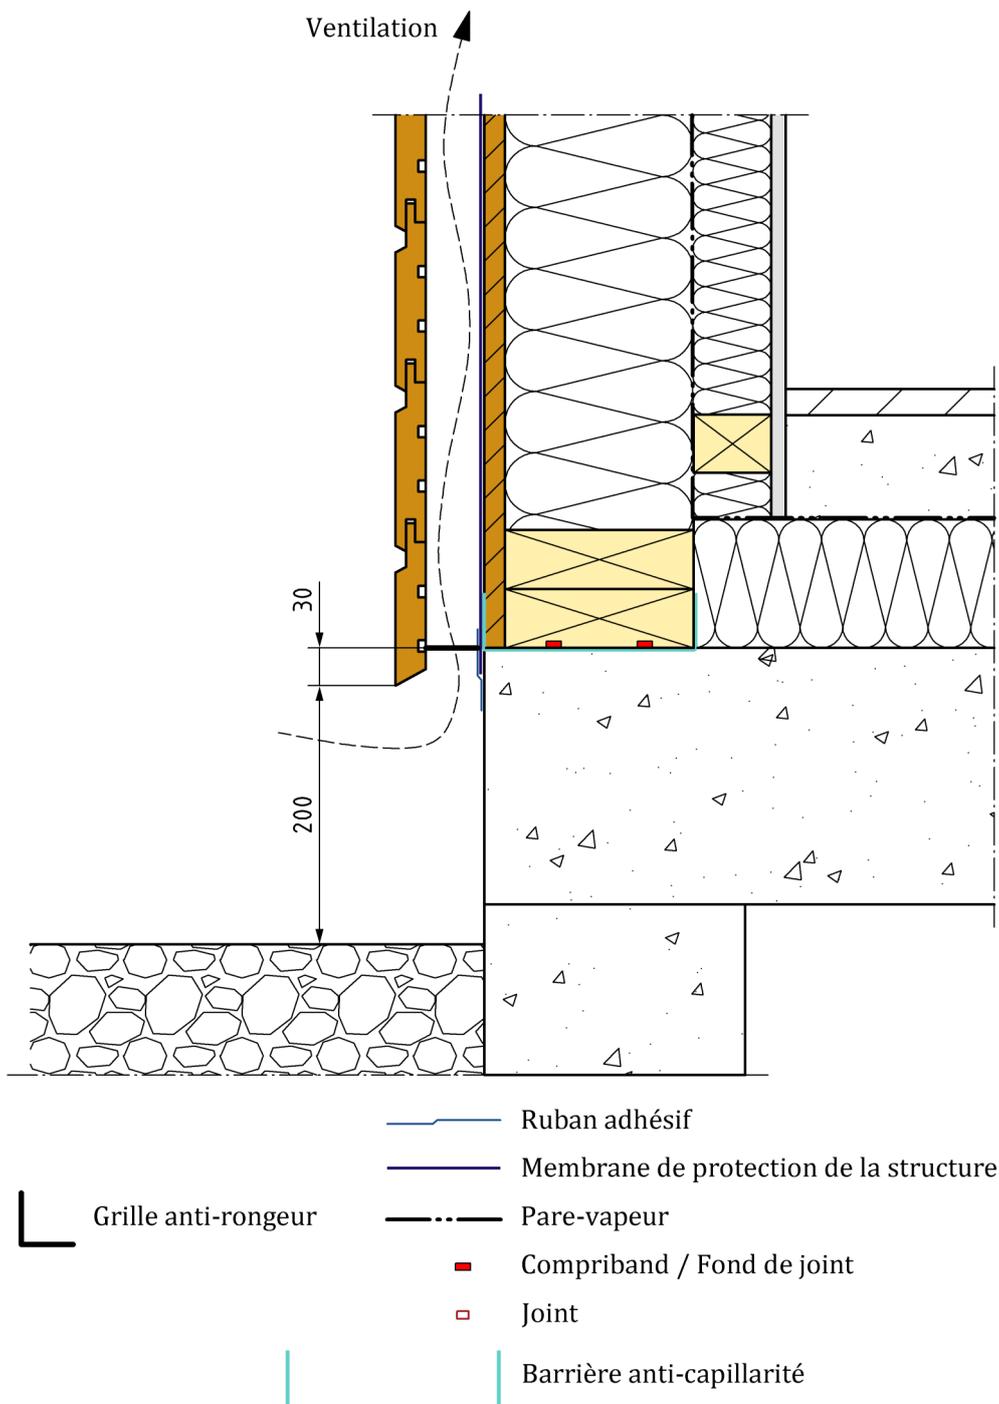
Exemple de dispositif en pied de bardage (larmier et 20 cm mini)
